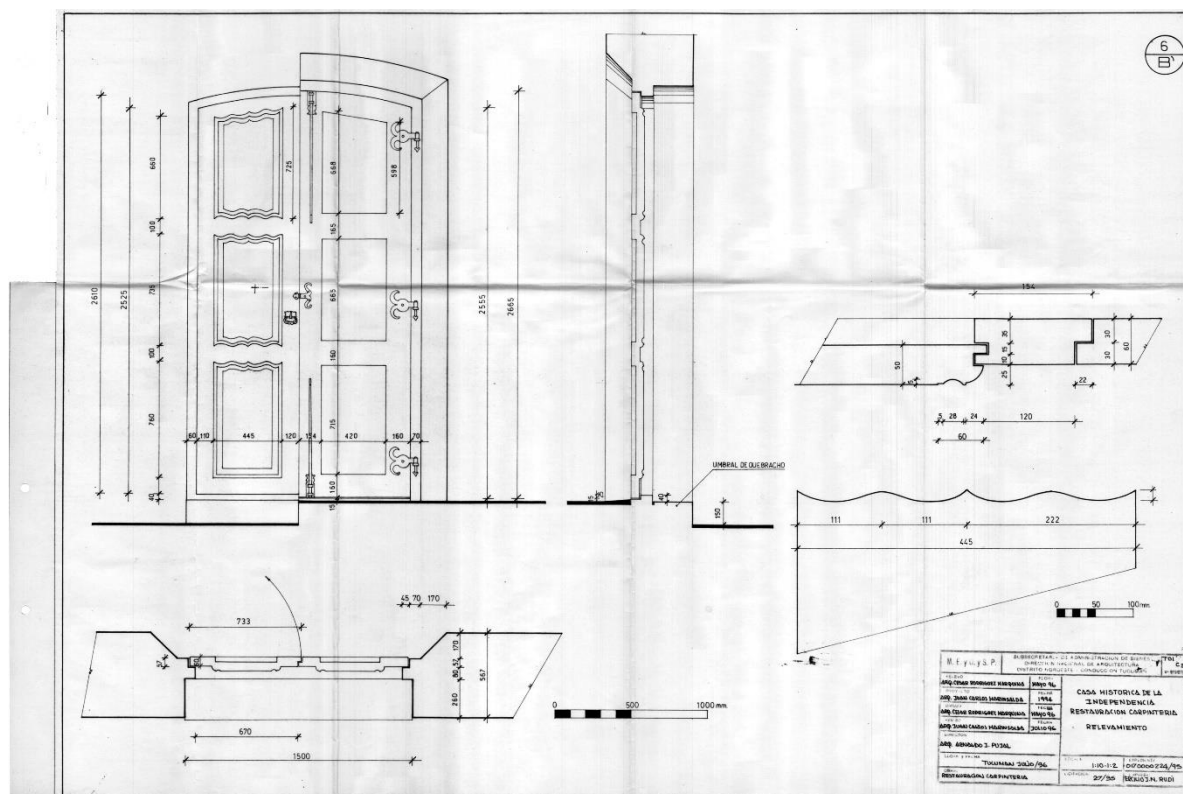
Plano de relevamiento puerta P 6 tipo B'. DNOA 1996
